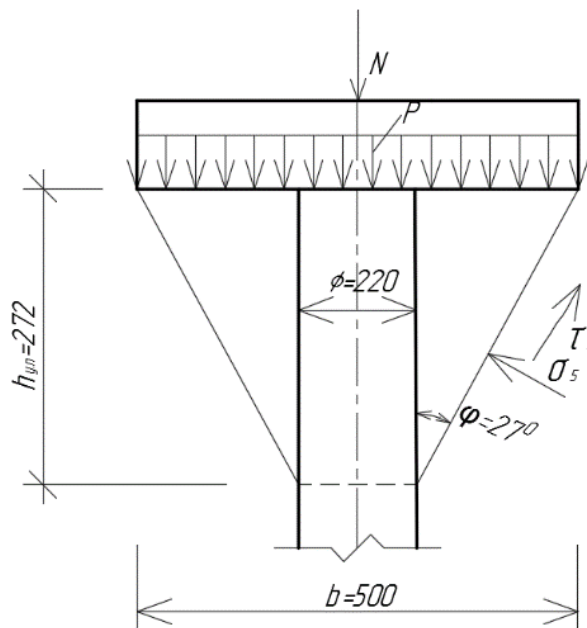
Расчетная форма уплотненного ядра грунта в форме усечённой пирамиды под квадратной подошвой фундамента (теоретическое построение)
